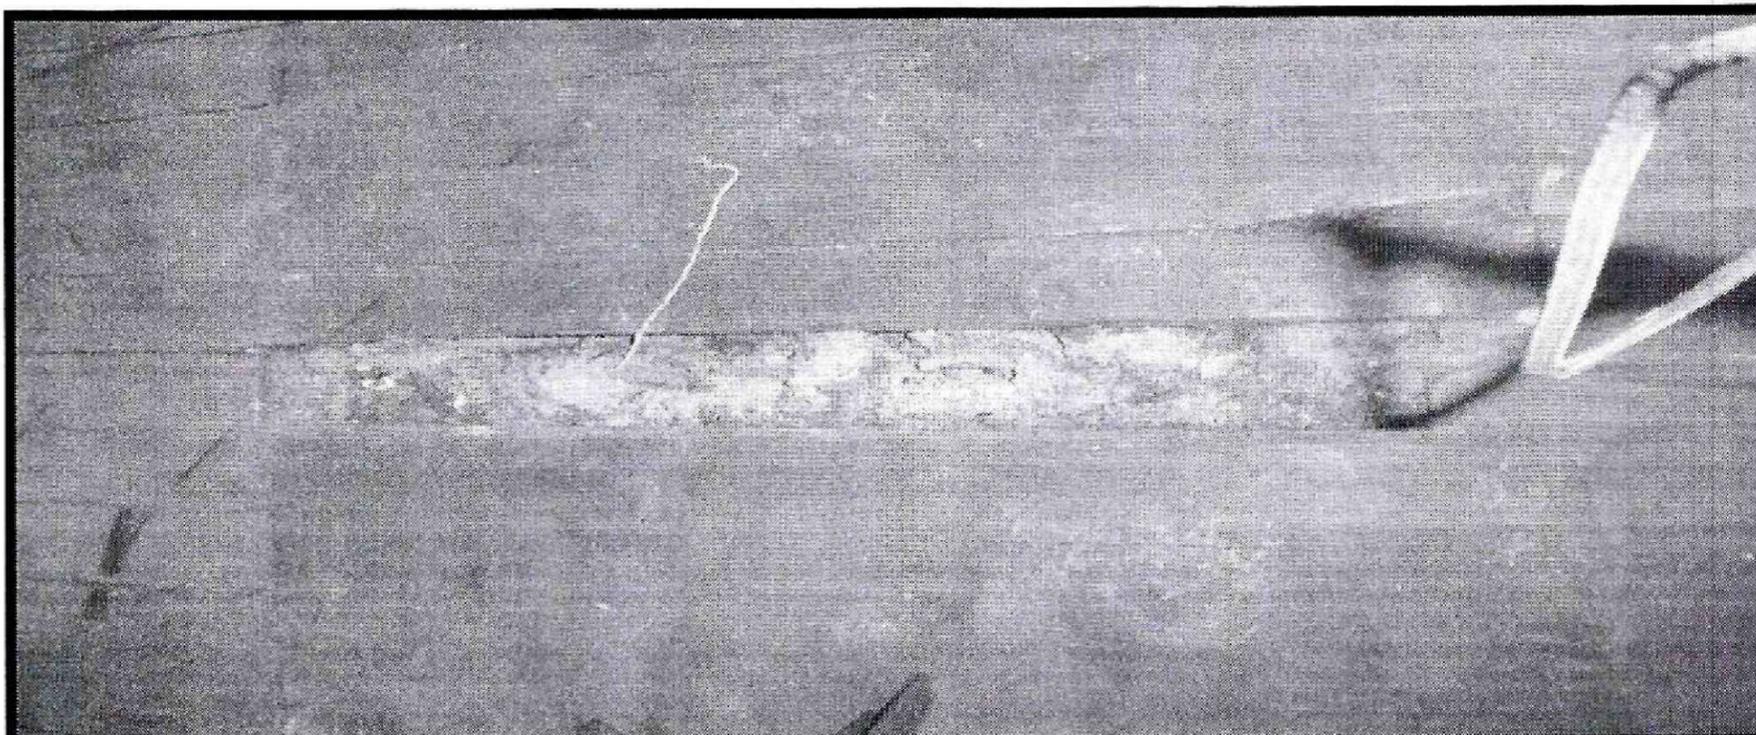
Manchas de humedad en el acabado de la torta inferior de la cubierta
